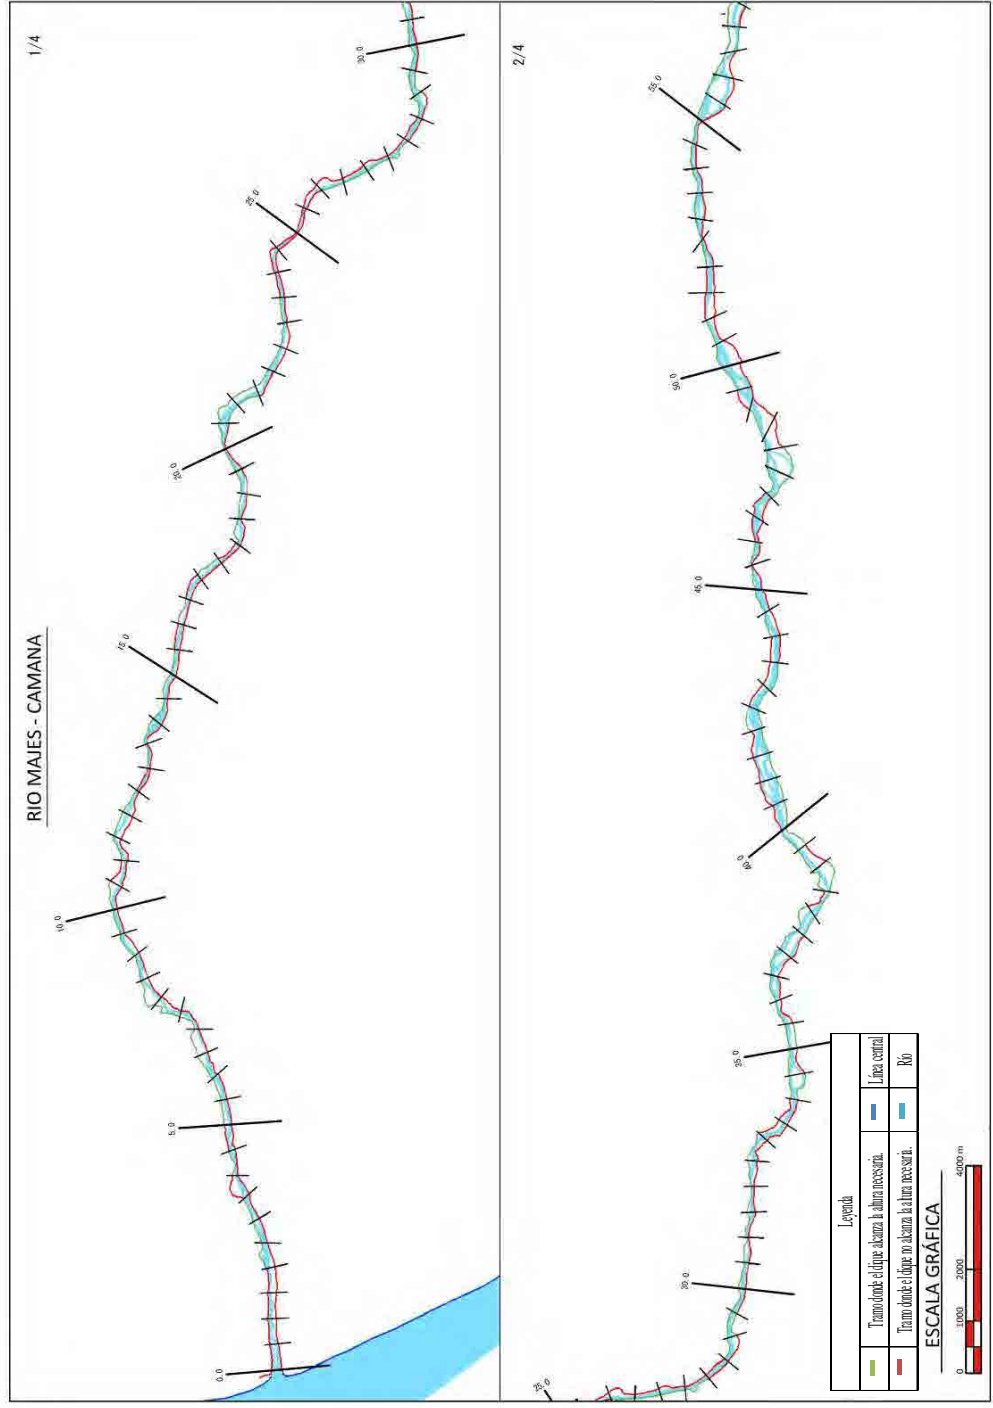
Plano de planta del Río Majes-Camana (0-55K)
